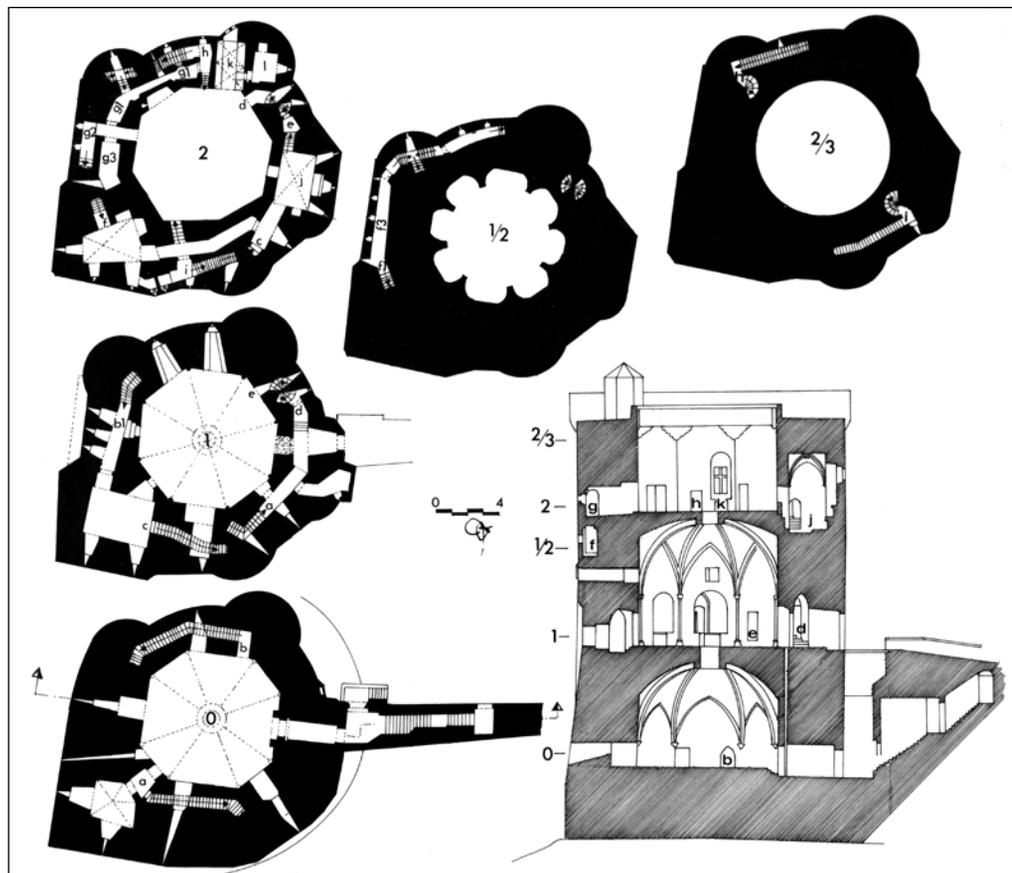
La Rochelle, tour Saint-Nicolas, plans et coupe (dessin J. Mesqui, 1989).
